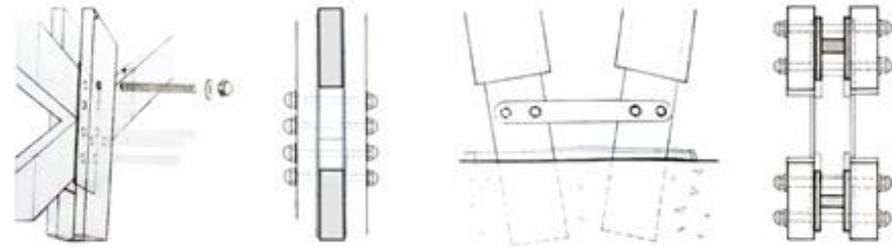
Imágenes tomadas de Trabajo Práctico de alumnos de la cátedra C3A
